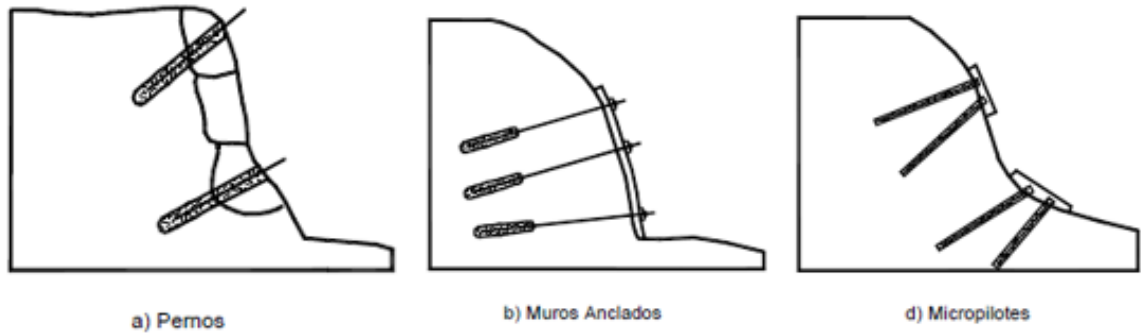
Tipos de estructuras ancladas (Suarez Diaz, 2013).
